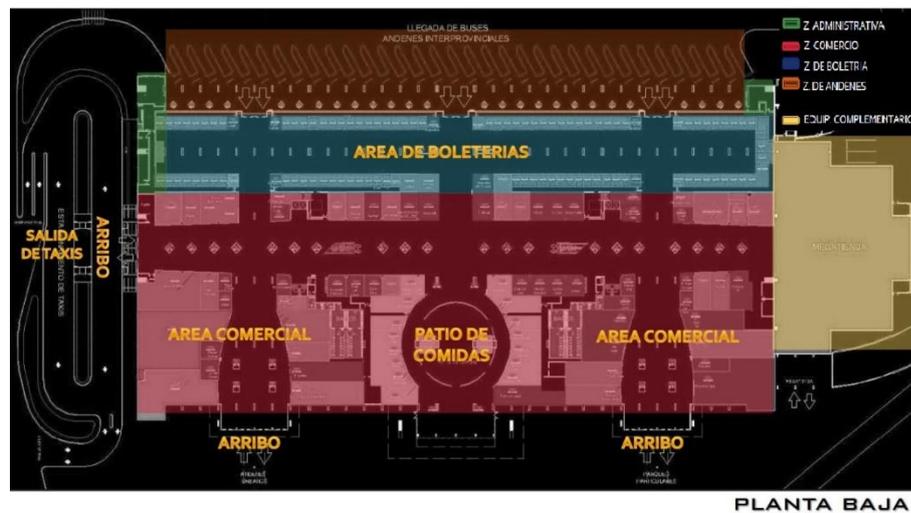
Zonificación (planta baja) - Terminal terrestre de Guayaquil
